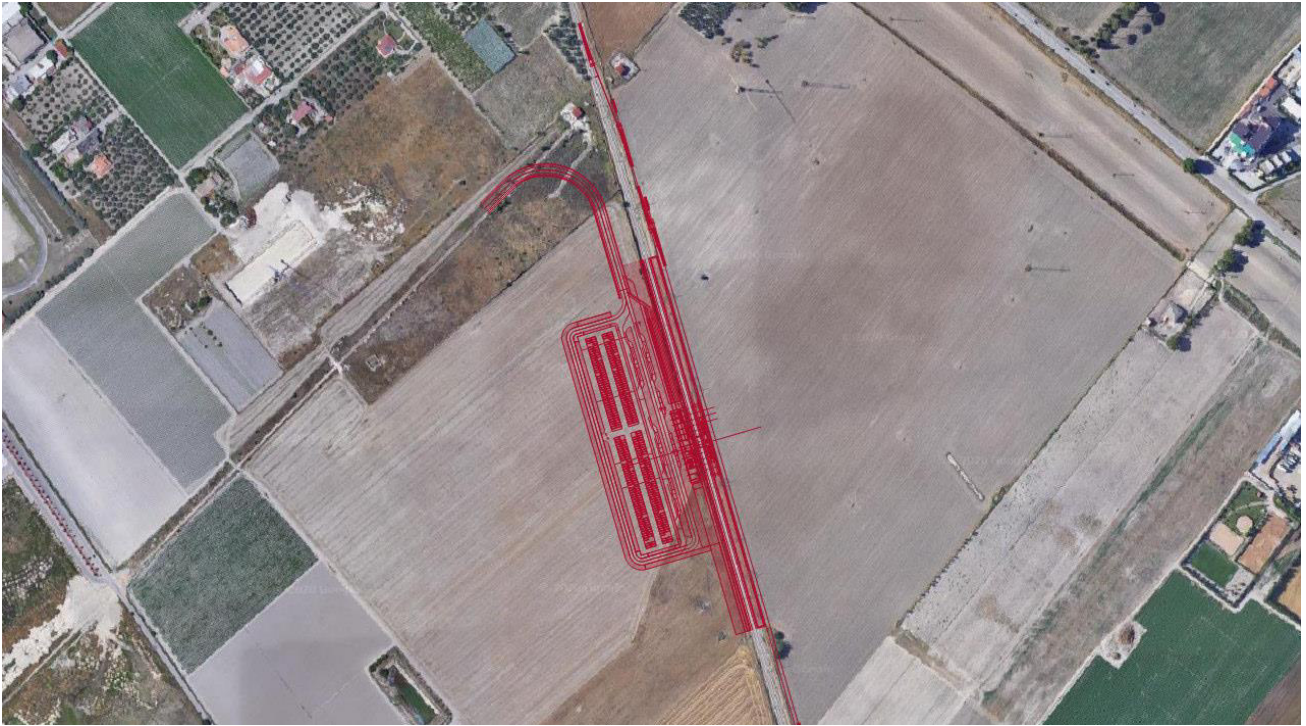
Stralcio planimetrico delle opere relative l'intervento
